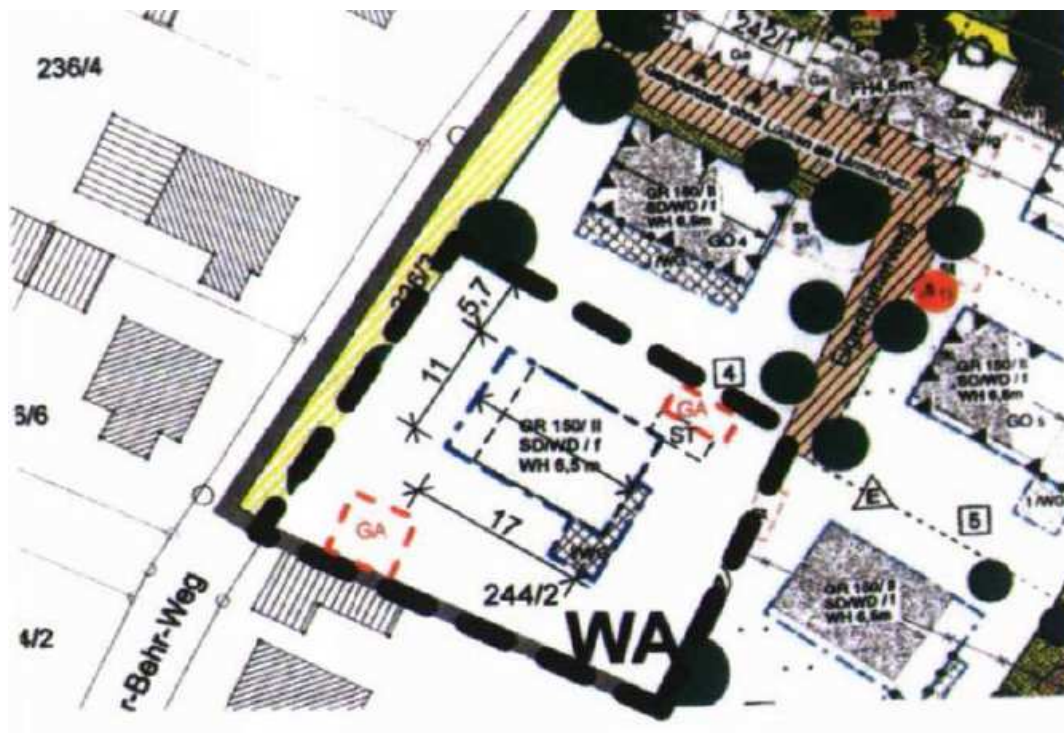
Lage des Auszug Planzeichnung 25. Änderung Bebauungsplan "Ortsmitte II"
